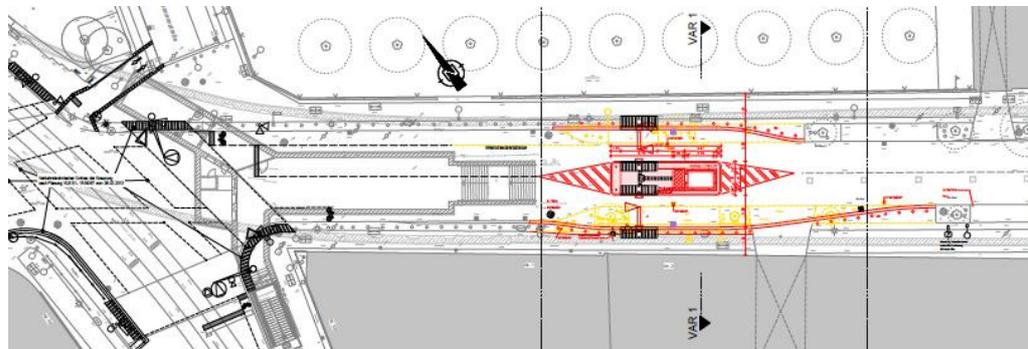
Übersicht Standortvarianten, Variante I, Ausschnitt Plan W_PG001
